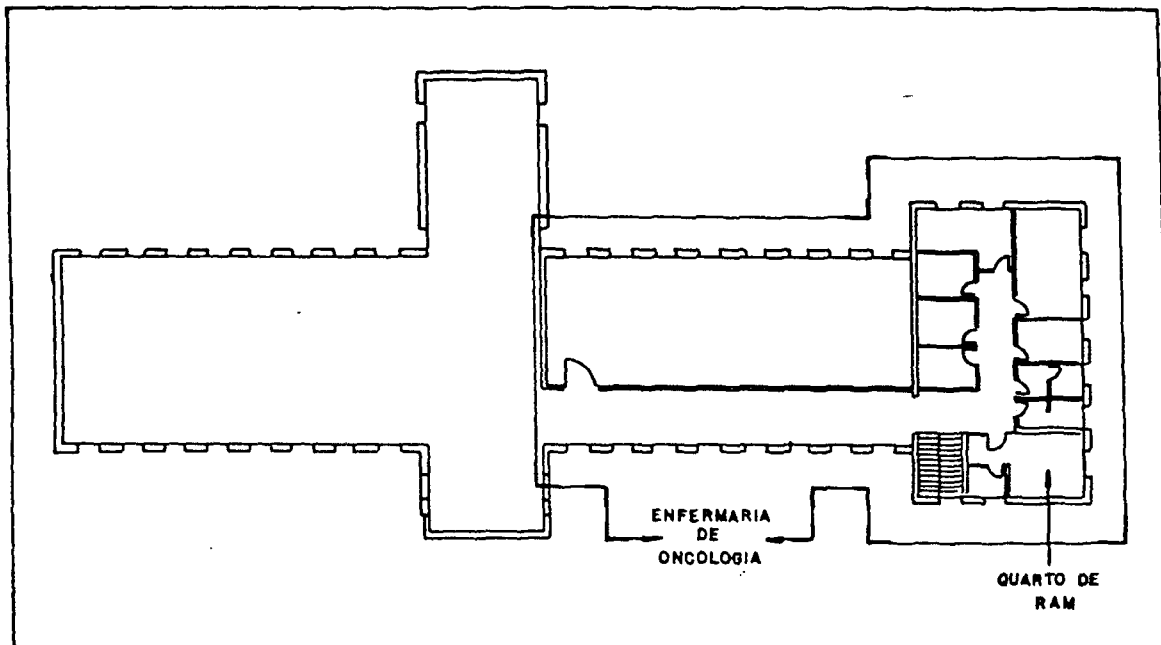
PLANTA BAIXA DO BLOCO I - CAISM
